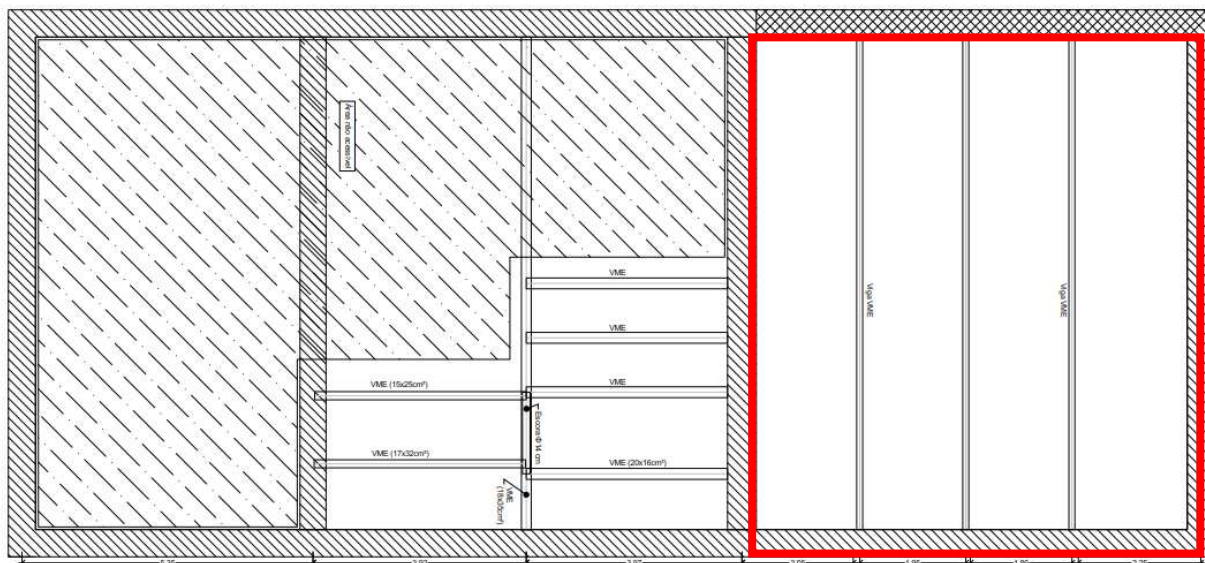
Levantamento estrutural dos elementos estruturais de suporte de teto
